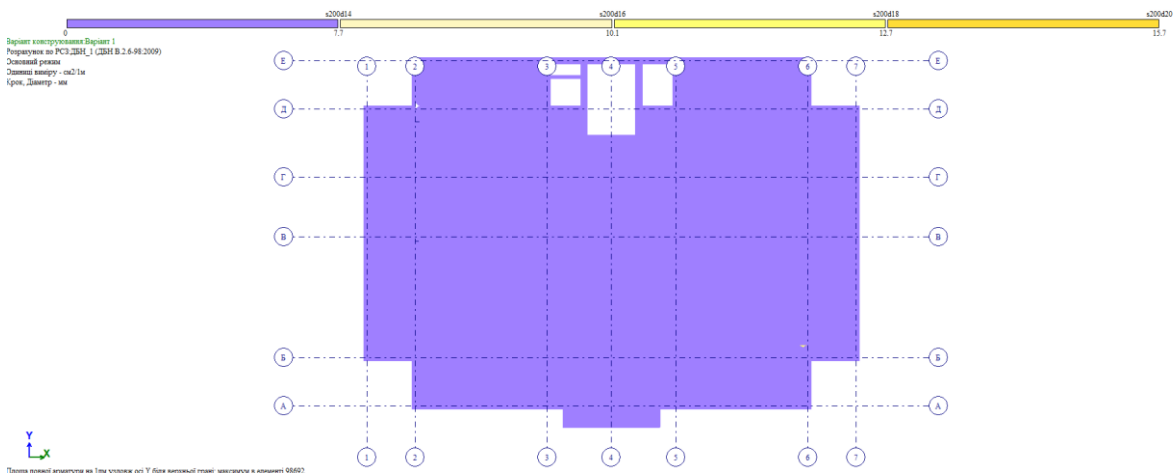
Площа арматури на 1 м. п. по осі y (верхня грань)
